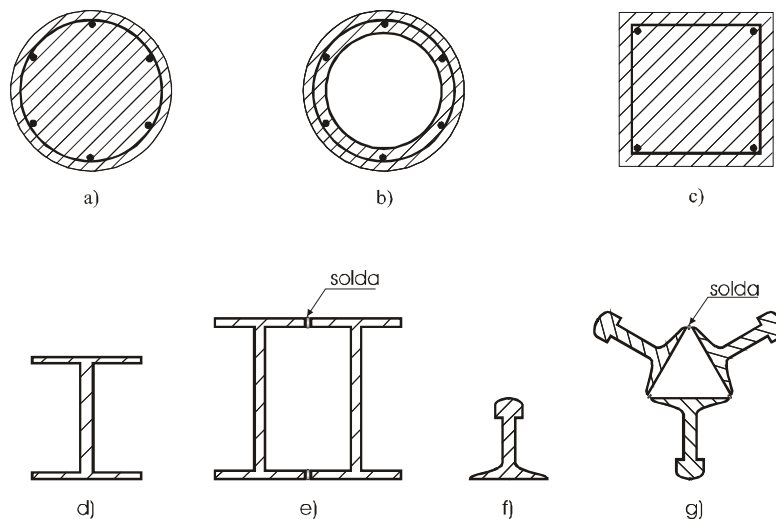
Exemplos de seções transversais de estacas: a) estaca circular de concreto; b) estaca circular oca de concreto; c) estaca quadrada de concreto; d) perfil metálico H ou I; e) perfil metálico duplo I; f) trilho simples; g) perfil formado por três trilhos soldados.
